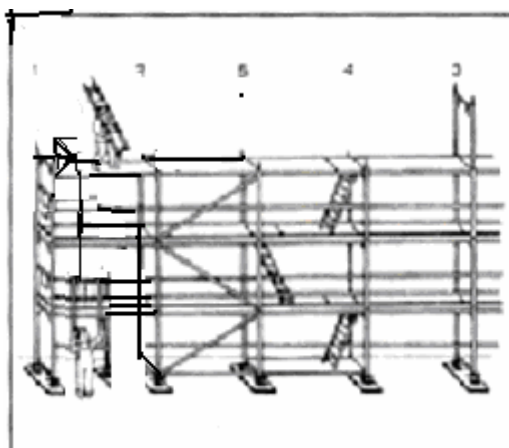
Montaggio/smontaggio con sollevamento degli elementi mediante un argano a livello del piano di assemblaggio.
